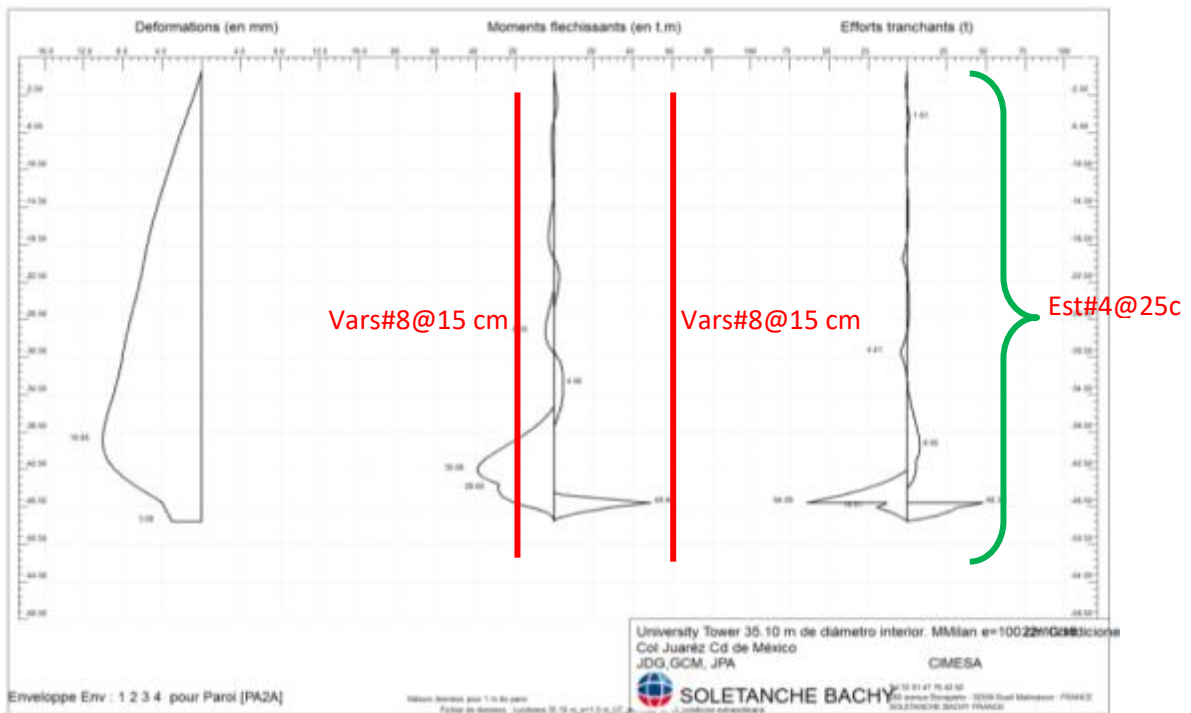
“Diseño a flexión y propuesta de refuerzo vertical en muro desplantado a -48.1 m, muro Milán circular e=1.00 m. Condición Extraordinaria”.
